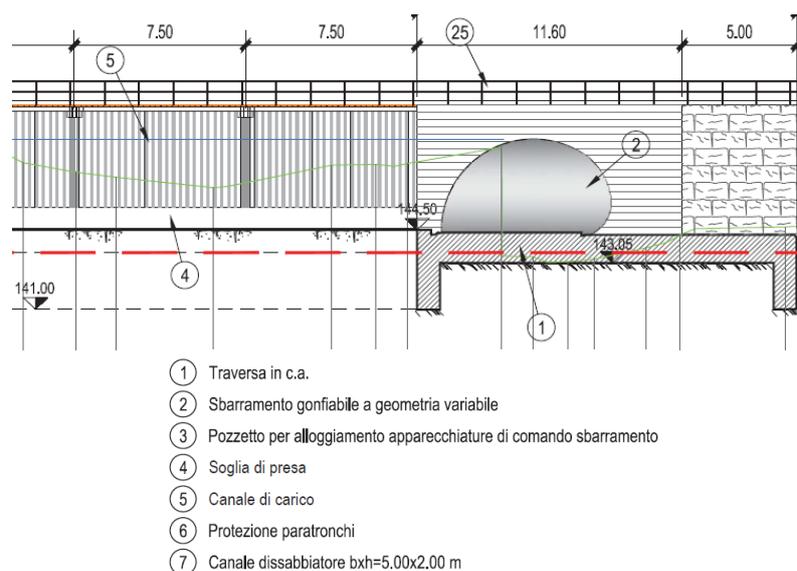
Estratto dell'Elab. 2 – Edificio centrale – Sezioni longitudinali e trasversali – Profilo F
